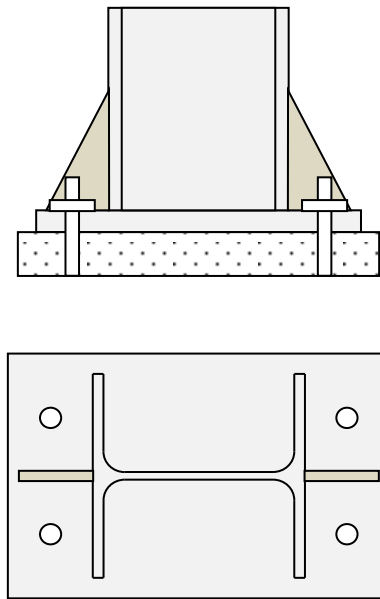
Raidisseurs dans le prolongement de l'âme du pied de poteau
